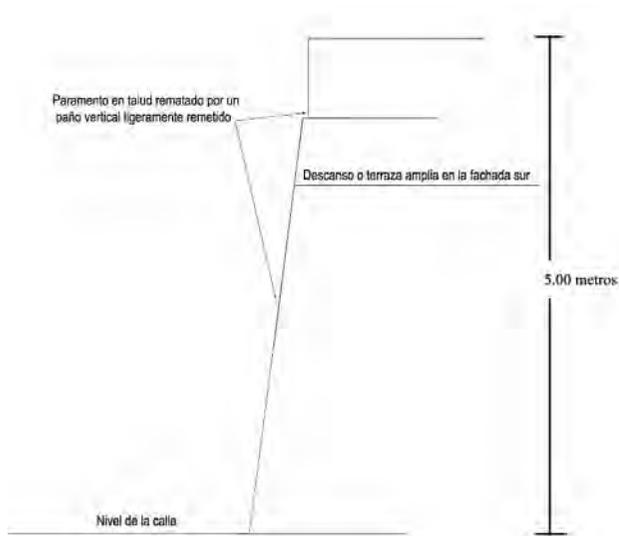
(plano 1) Croquis de corte longitudinal (este a oeste) de la fachada sur de la plataforma.
